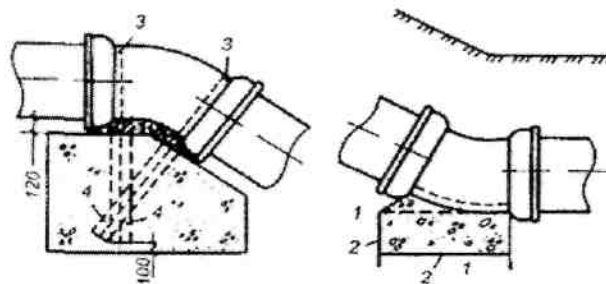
Упори для чавунних розтрубних підземних труб при повороті у вертикальній площині: 1 – непорушений ґрунт; 2 – опорна поверхня; 3 – хомути; 4 – анкерні болти.
